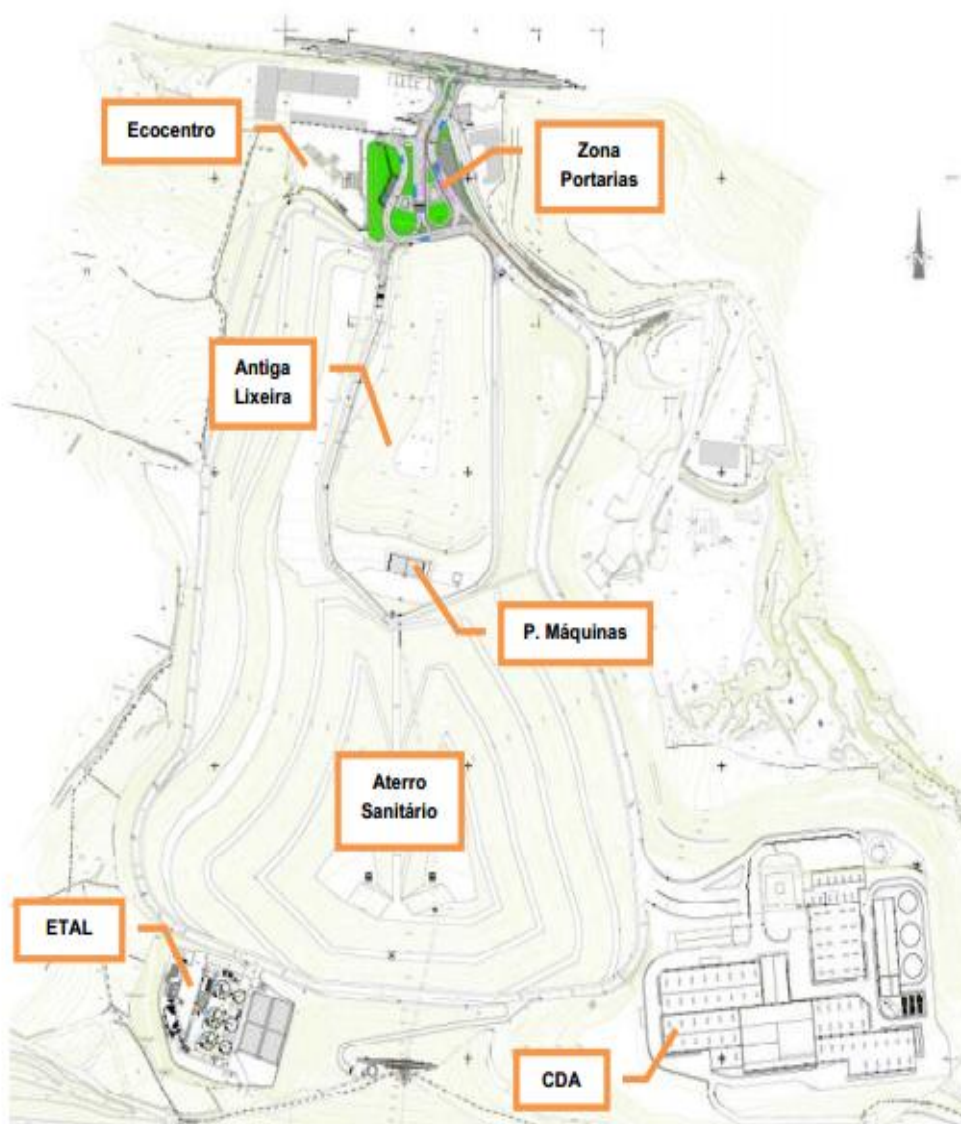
PLANTA DO ECOPARQUE DA ABRUNHEIRA [1]
